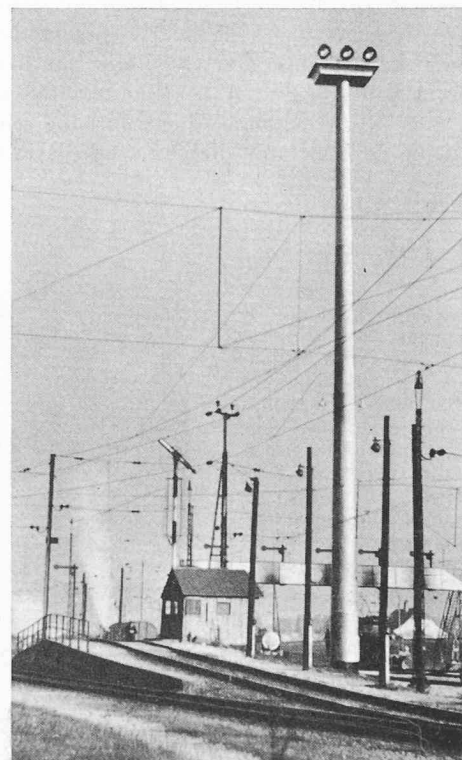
Tour d'éclairage n° I. Au premier plan, la bosse de débranchement (A).
